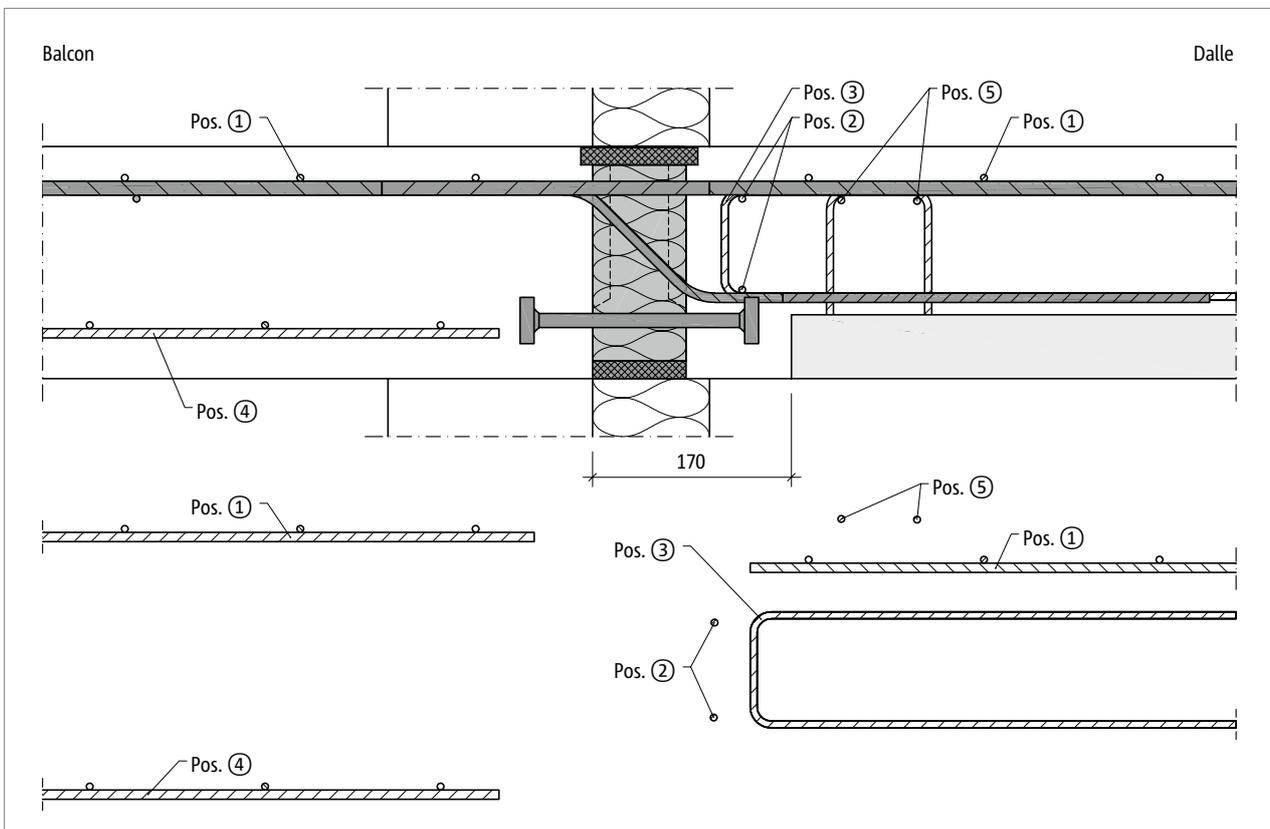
Schöck Rutherma® T type DB : armatures à prévoir par le client en association avec des planchers avec prédalles
